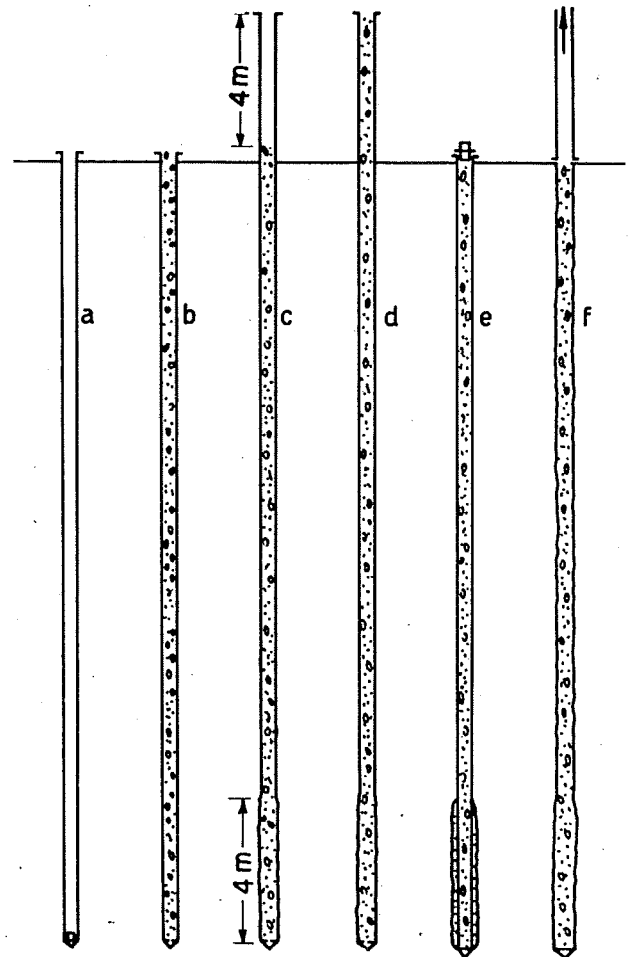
2° Lavoro - Esecuzione di uno speciale palo SIMPLEX
